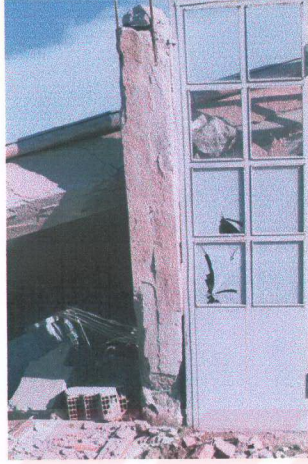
Çay Sanayi Sitesi , detay, kolon bitiminde donatı ankrajı ve etriye yok
